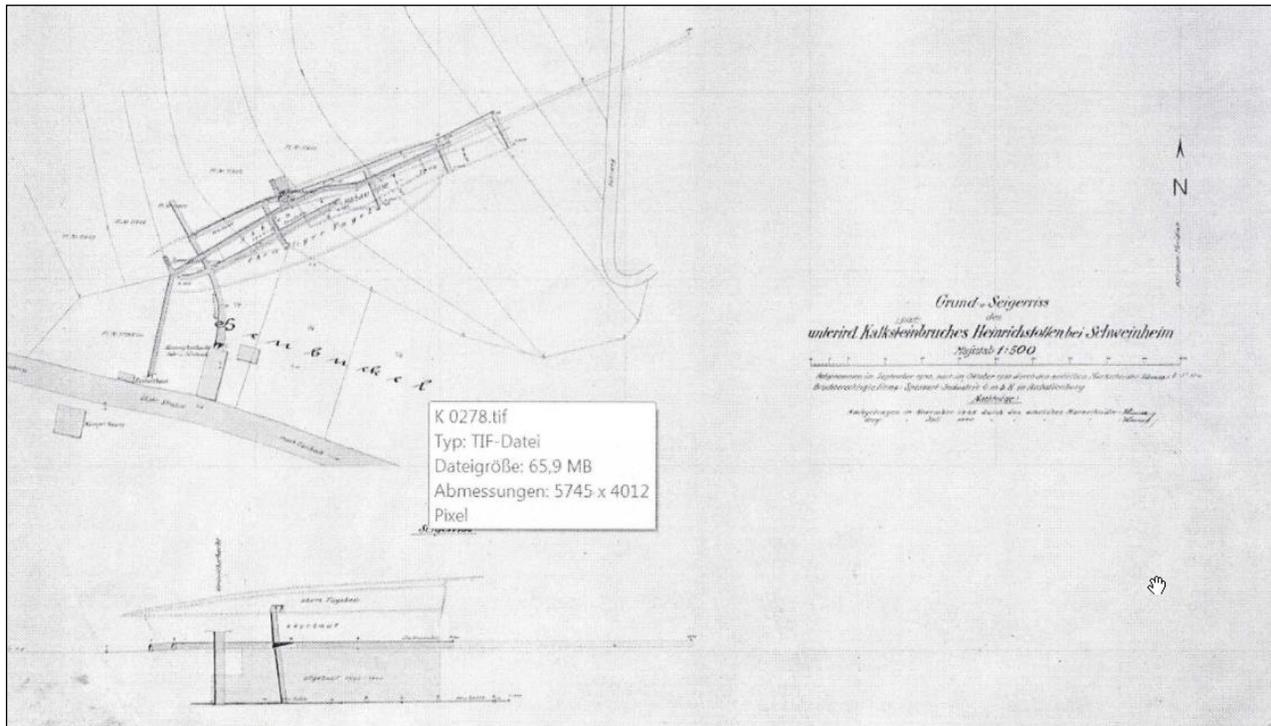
Grund- und Seigerriss des Heinrichstollens an der Einmündung des Reiterweges in die Gailbacher Straße
